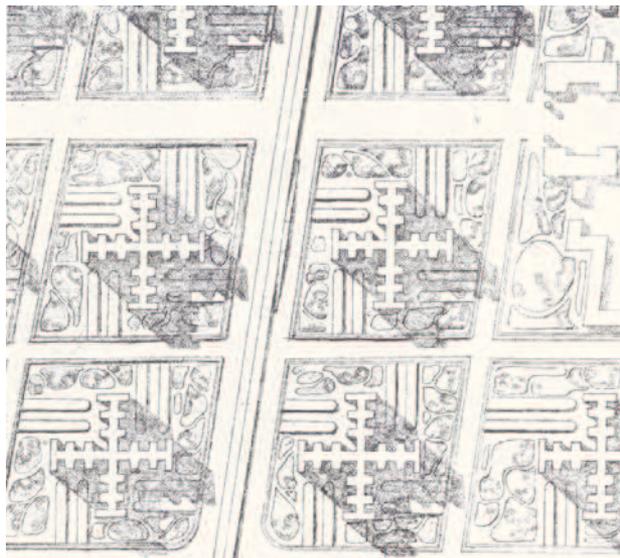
Le Corbusier, Plan Voisin di Parigi, 1925, vista prospettica dell'area centrale.
